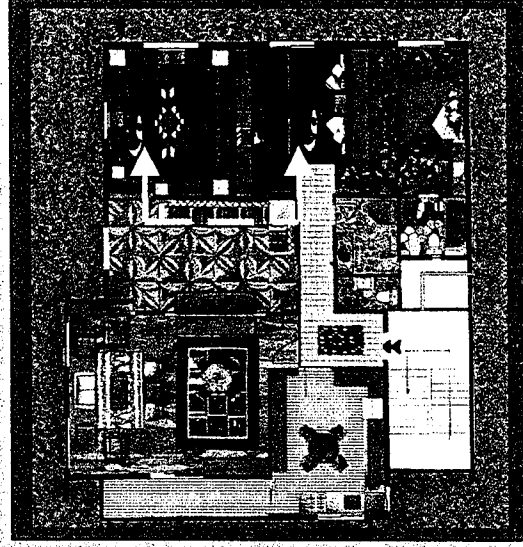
/١٣٧) مسقط أفقي موضح عليه قطاع بغرفة النوم الرئيسية
